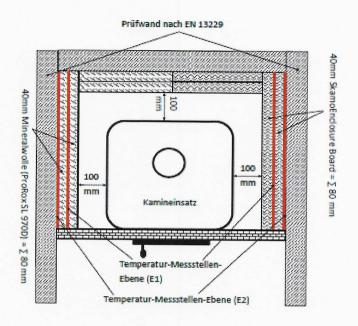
Draufsicht-Schnitt: Prüfaufbau Versuchstag 1: 80 mm SkamoEnclosure Board und 80 mm Mineralwolle
